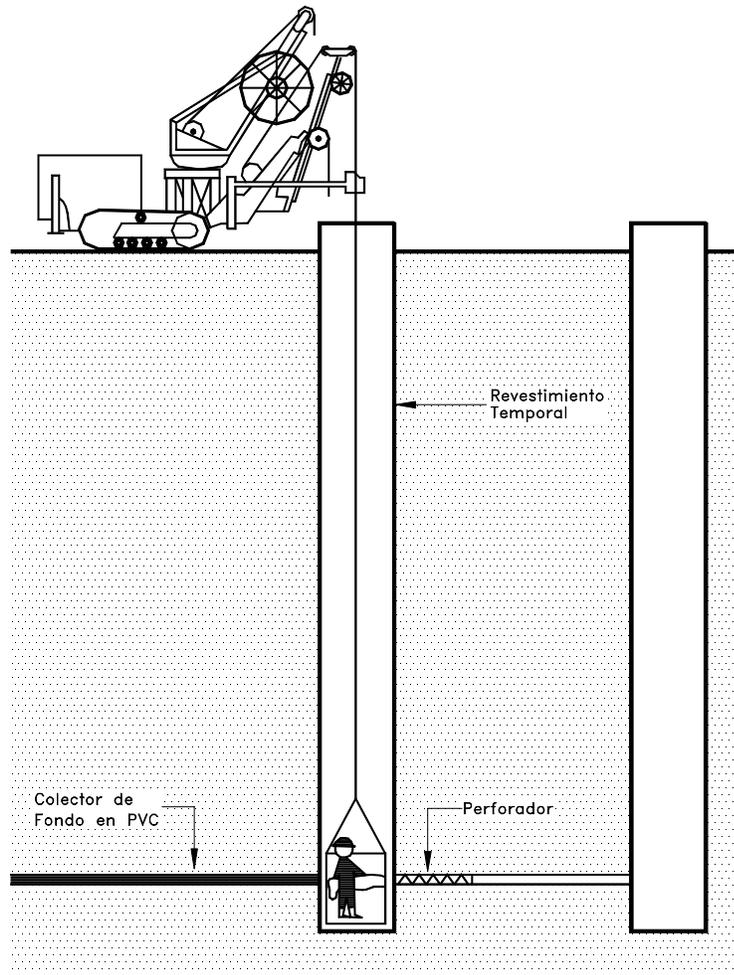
Construcción de ductos de conexión entre pozos verticales.
